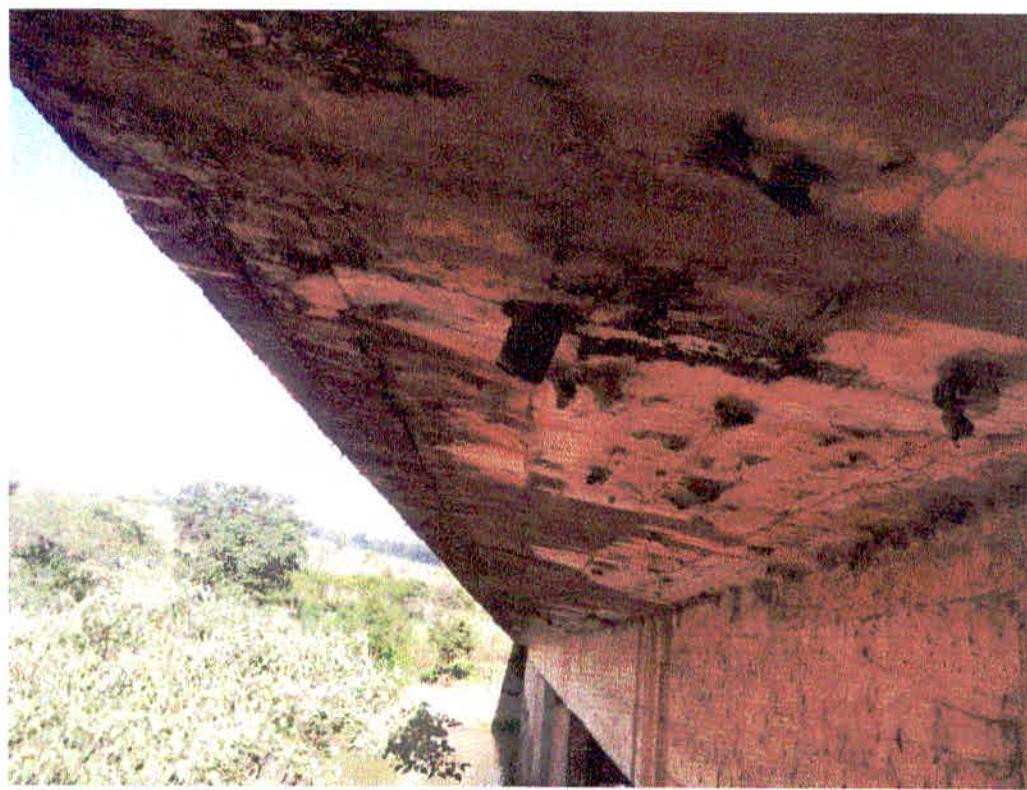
Foto 14 Vista Inferior Laje de Concreto Armado – Lixiviação e Mancha de Carbonatação / Infiltração no Concreto
